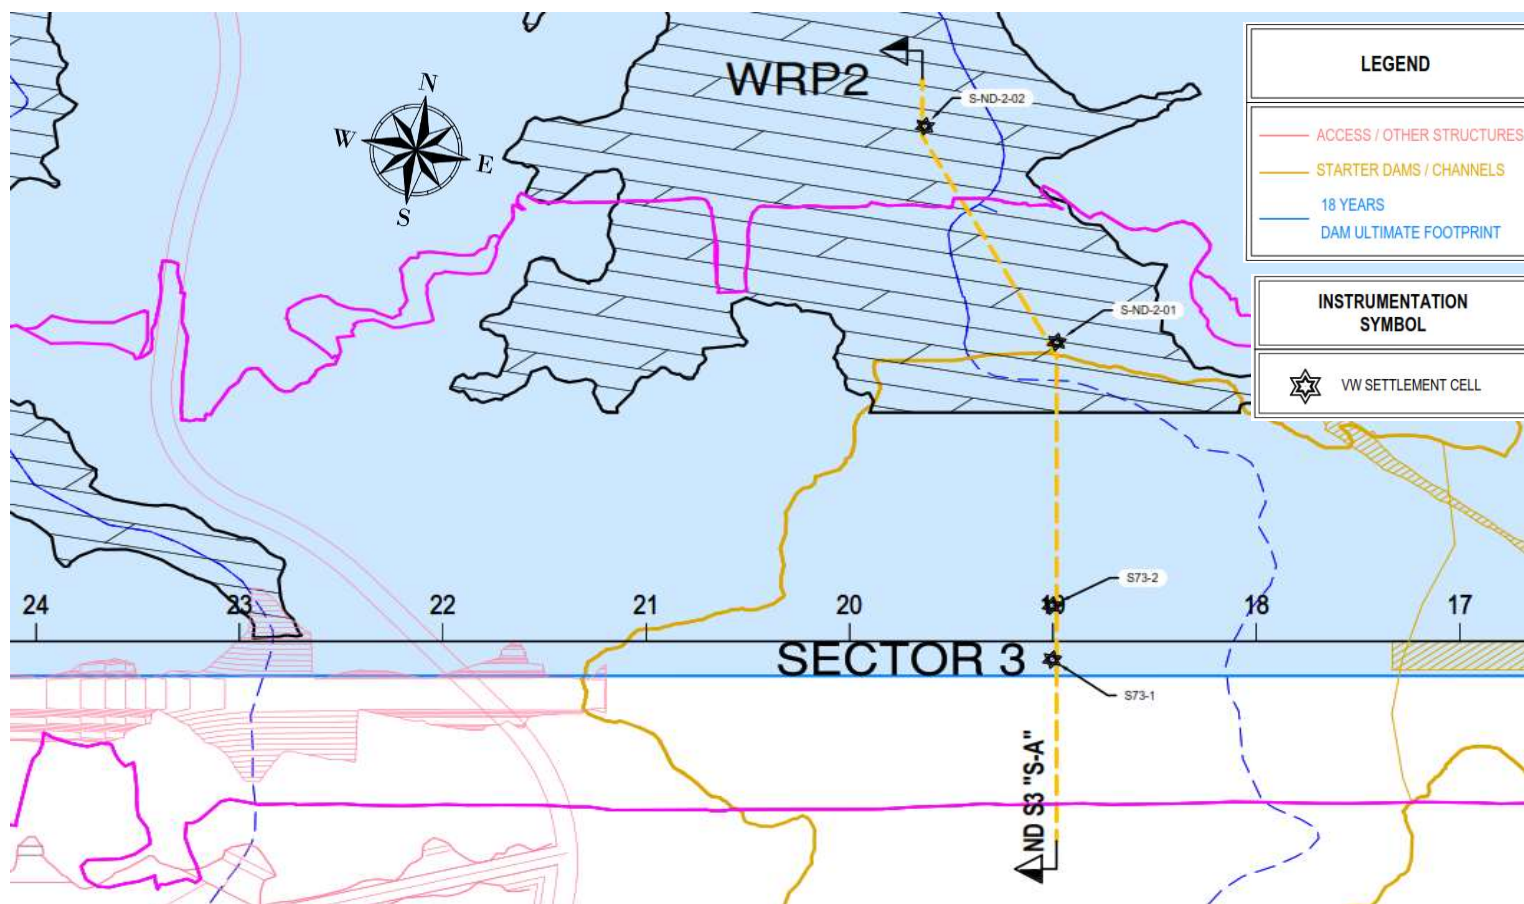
1: Vista en planta del sector 3 de ND - Grupos de instrumentos de células de liquidación
